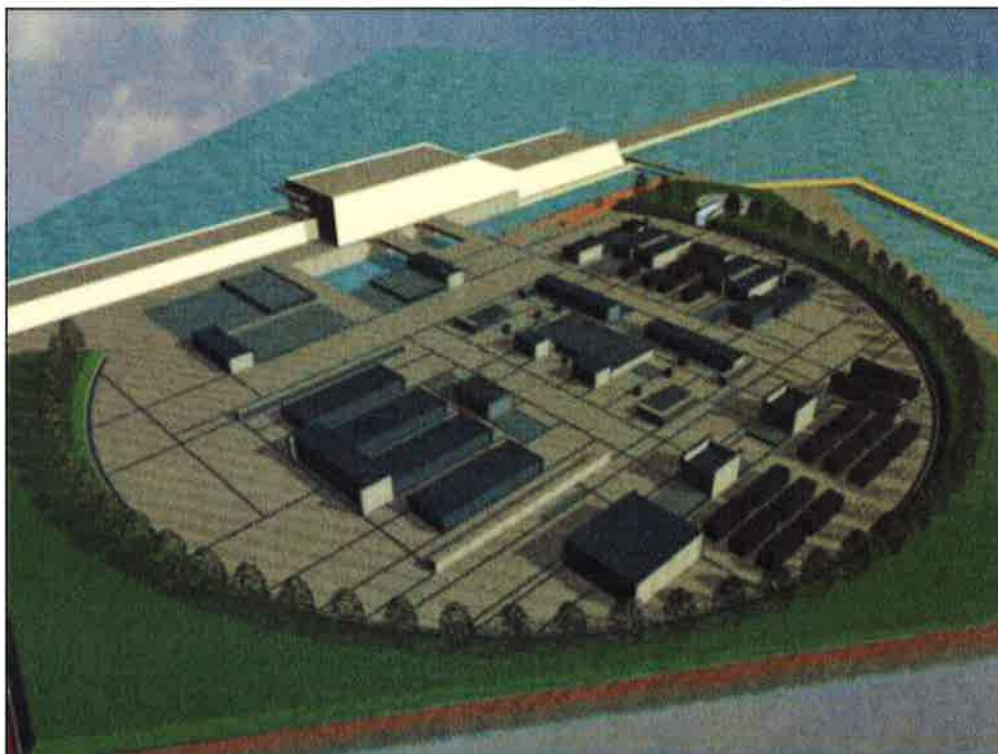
RENDERING PRELIMINARE DELL'AREA IMPIANTI PRESSO LA SPALLA NORD DI S. NICOLÒ
